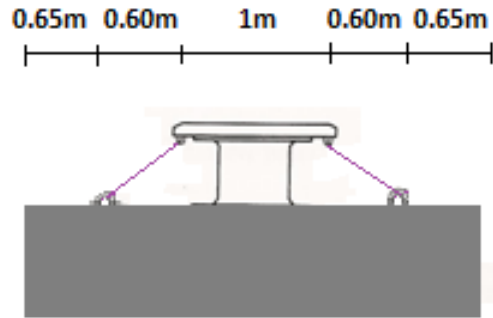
Vista en planta de la colocación de las cadenas de cortante (Fuente: del Autor)
